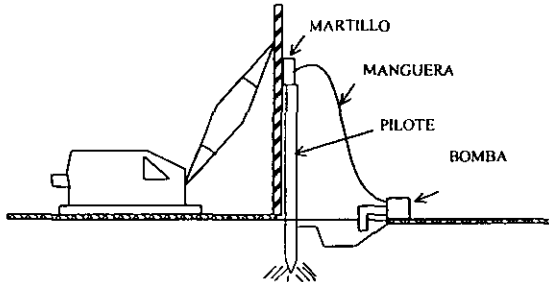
PILOTE HINCADO CON CHIFLÓN
